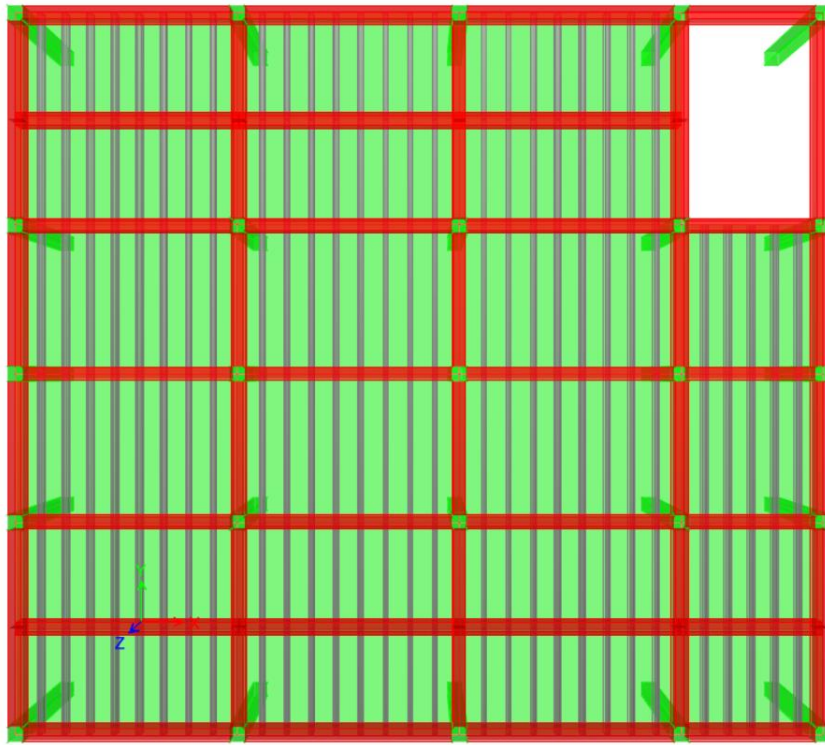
Distribución estructural en planta [Espinoza y Vásquez, 2023]
